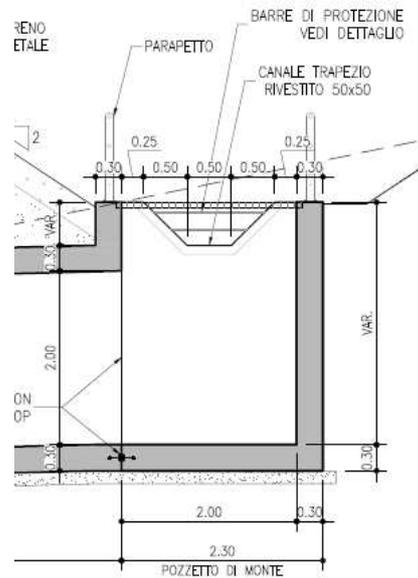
Manufatto d'imbocco - Sezione longitudinale
